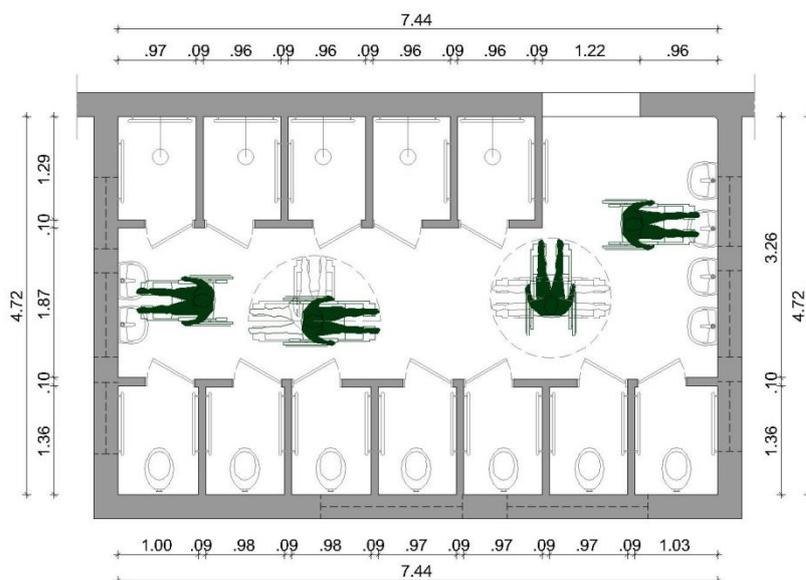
ILPI 2 - Planta baixa banheiro coletivo feminino B.
